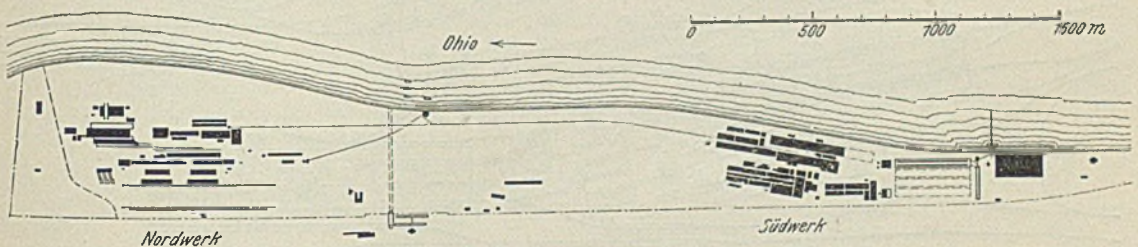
Lageplan des Werkes der Jones & Laughlin Steel Company in Aliquippa.
